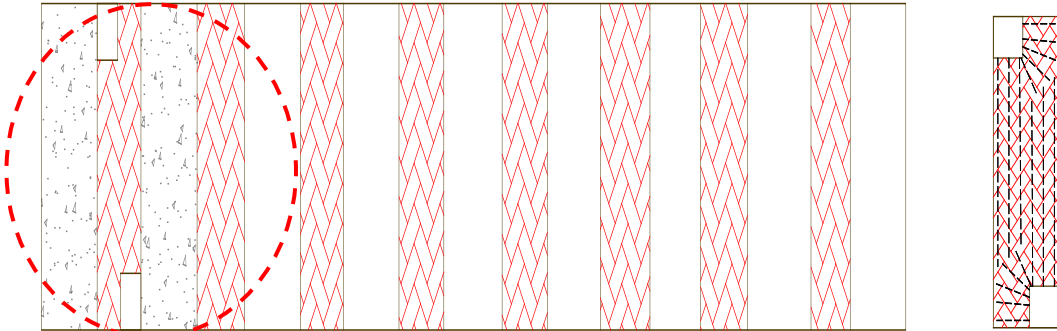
Continuación del minado, se abren los pilares superiores e inferiores del primer tajeo secundario (primer pilar a recuperar). Sección Longitudinal.
